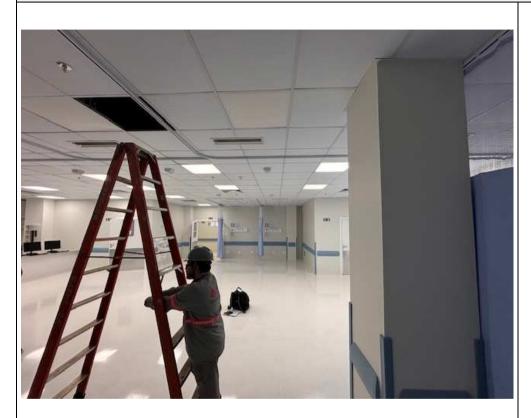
Detalhe do andar inferior diretamente abaixo da sala de exames onde deverá ser instalada estrutura para posicionar chapas de Silício.
